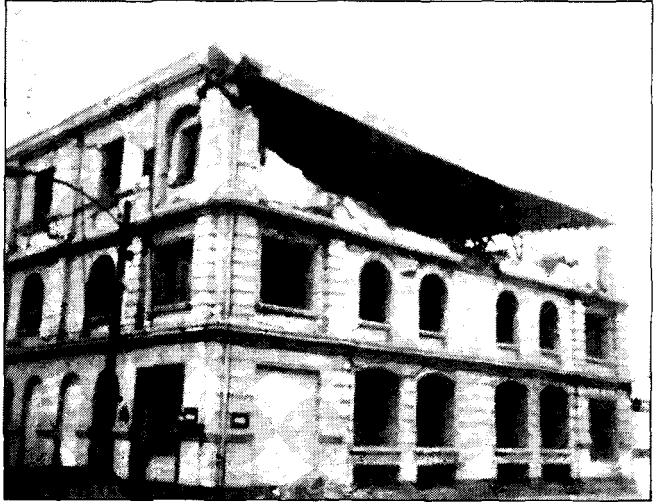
Falla por carga ortogonal al plano del muro.
